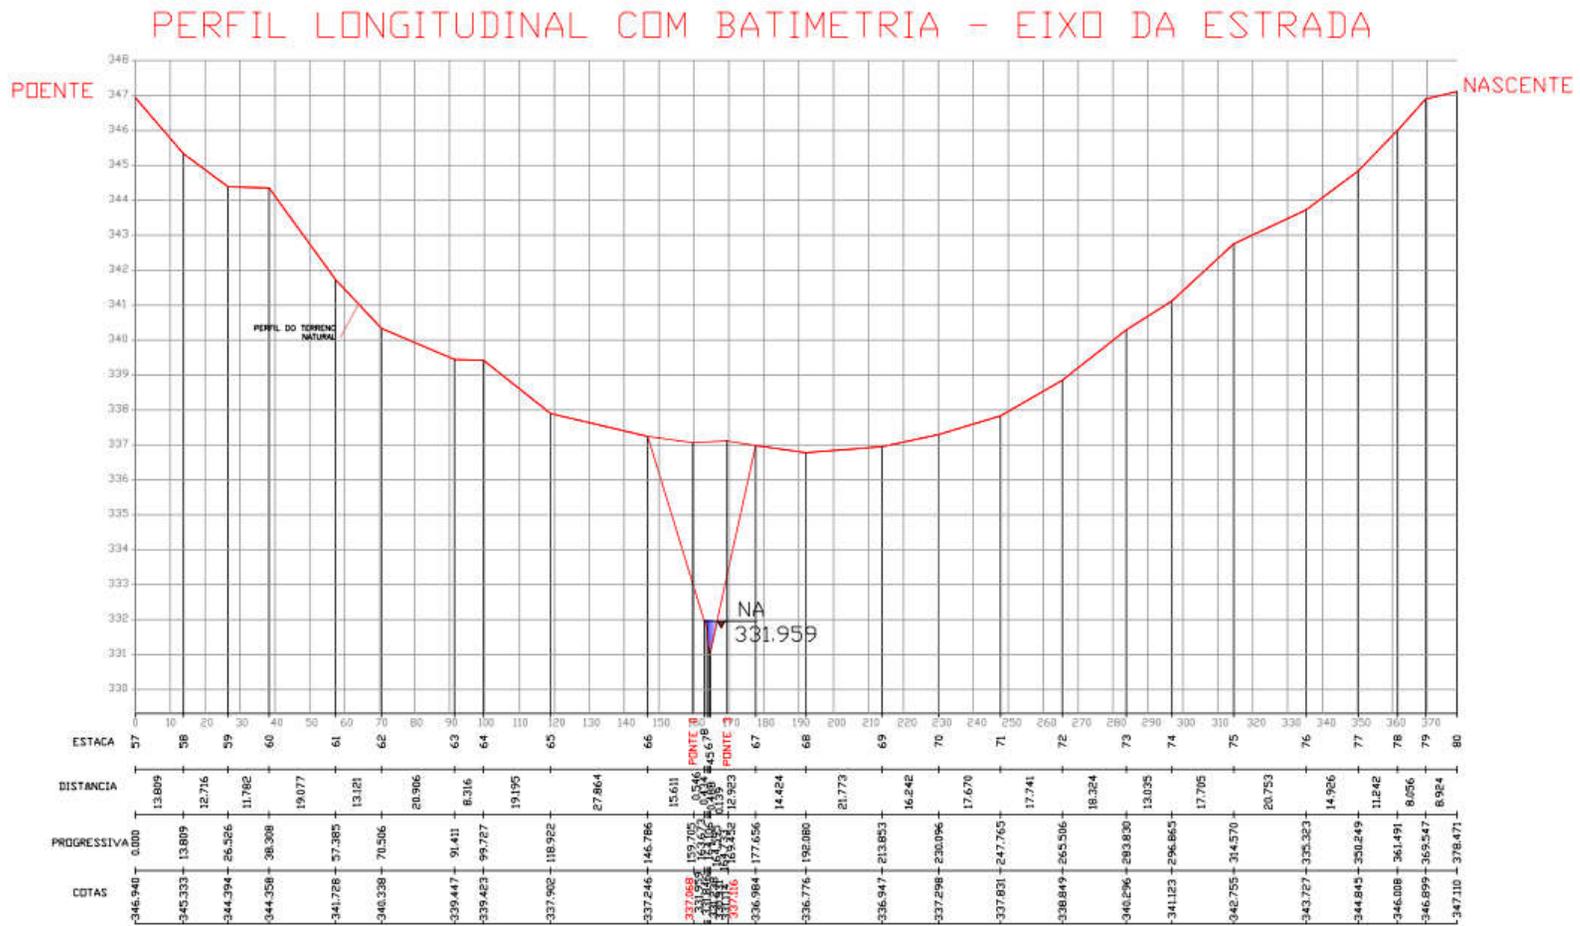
Perfil Transversal do Córrego Zé Barreto (Detalhado na prancha 02-02 do projeto)
